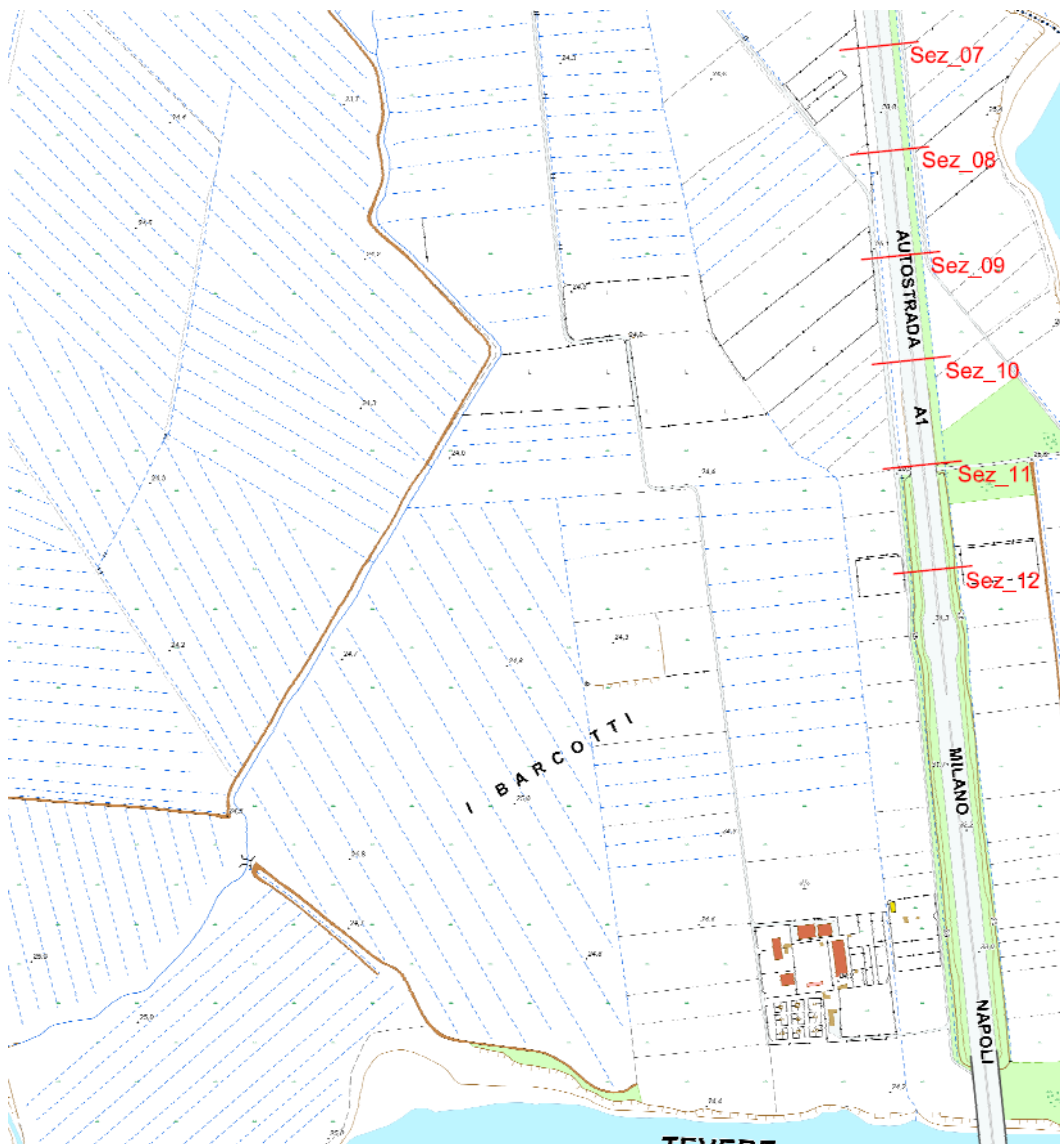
Sezioni del rilevato autostradale nell'area di progetto (7 – 12)
